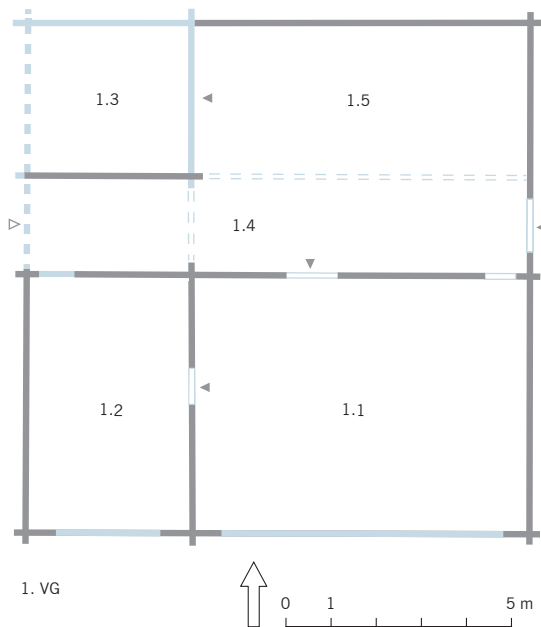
Eggstrasse 57 in Oberägeri, Grundriss des ersten Vollgeschosses.
